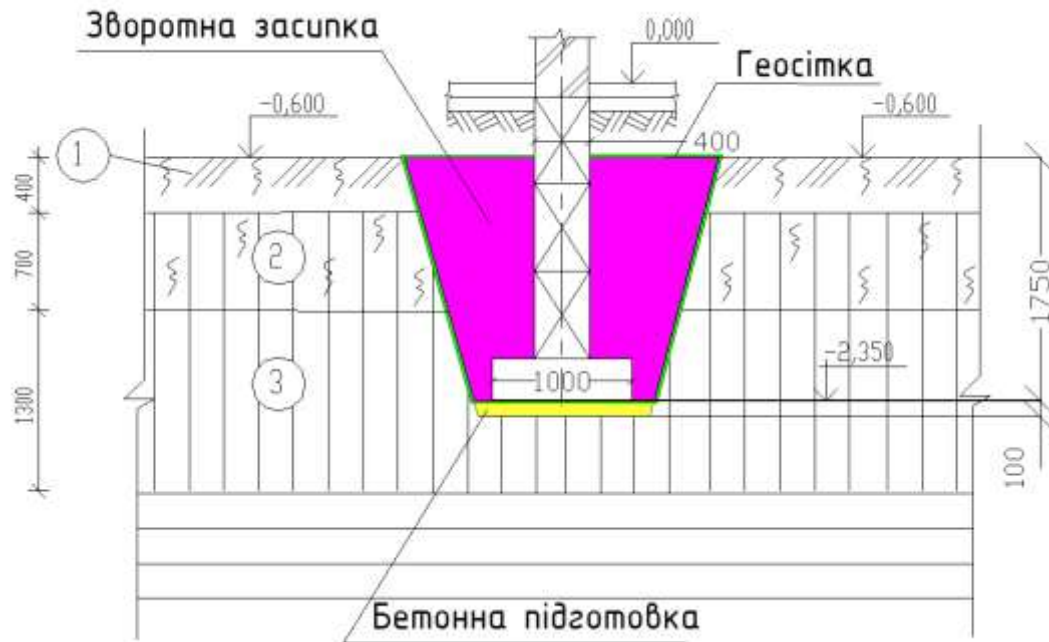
Поперечний розріз фундаменту пропонованої конструкції
